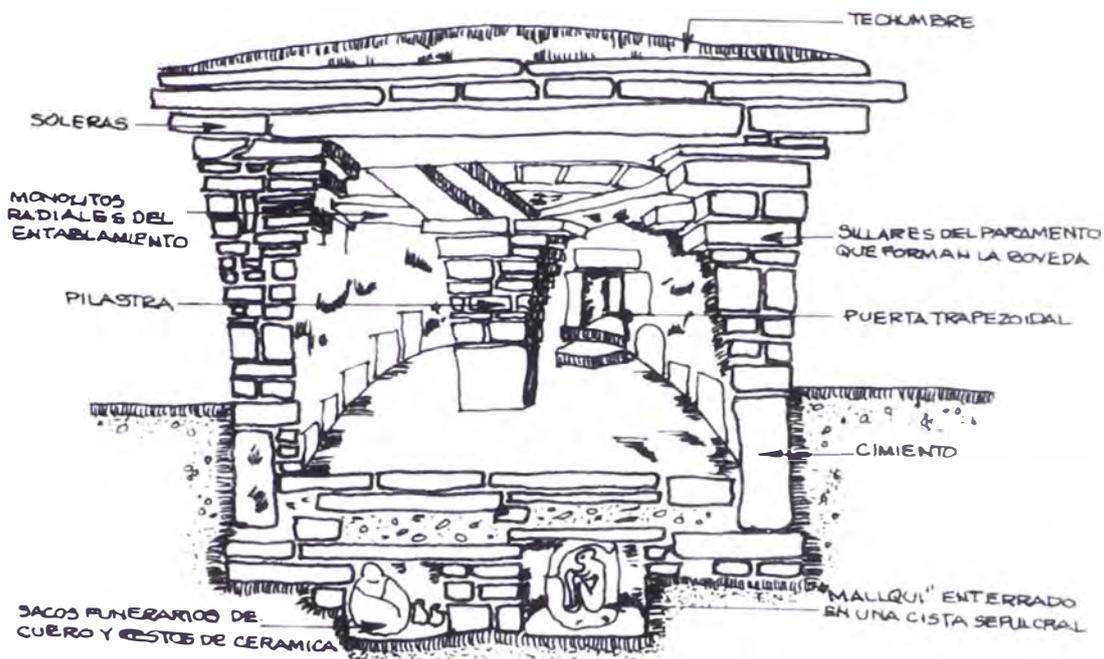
CORTE VERTICAL DE UN "KULLPI DE SANTA MARÍA"
